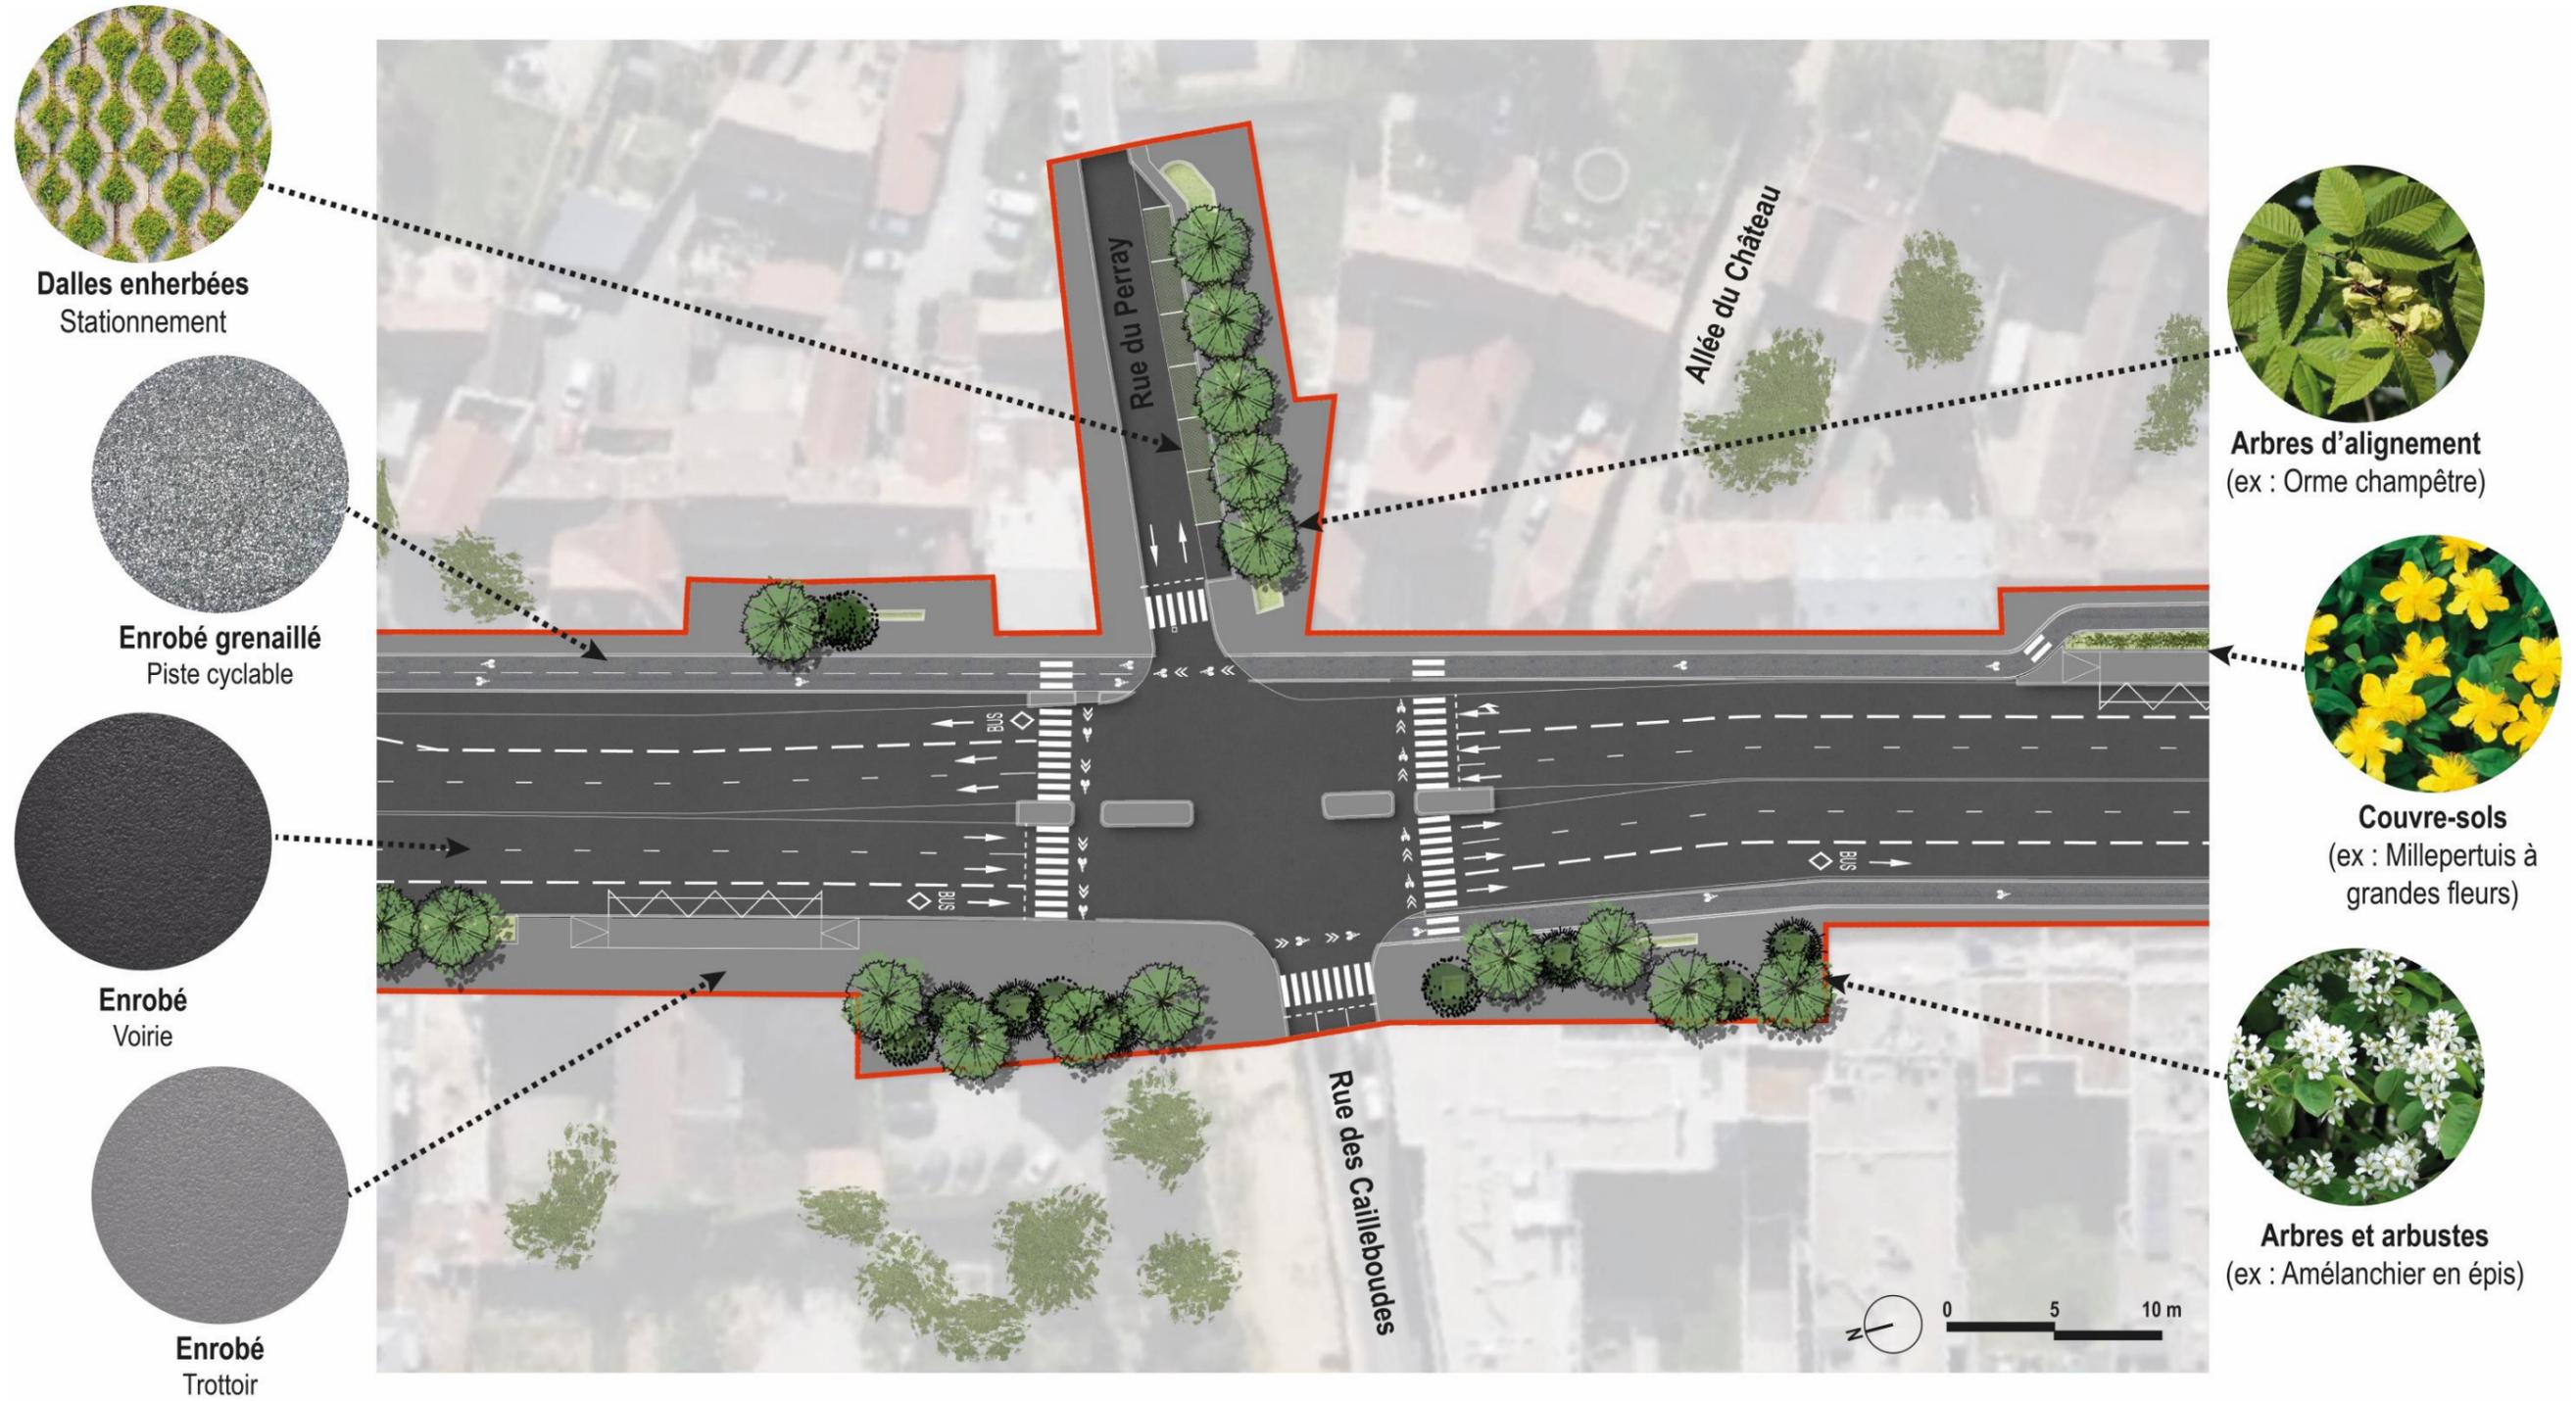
Planche d'aménagement de la place du Château, Source : Ingérop
